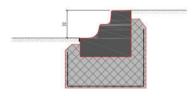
Détail bordure arrêt de bus LHand, hauteur 22 cm.
